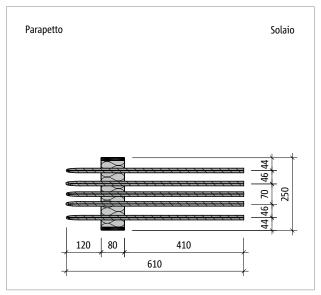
Schöck Isokorb® T tipo AP: sezione del prodotto
